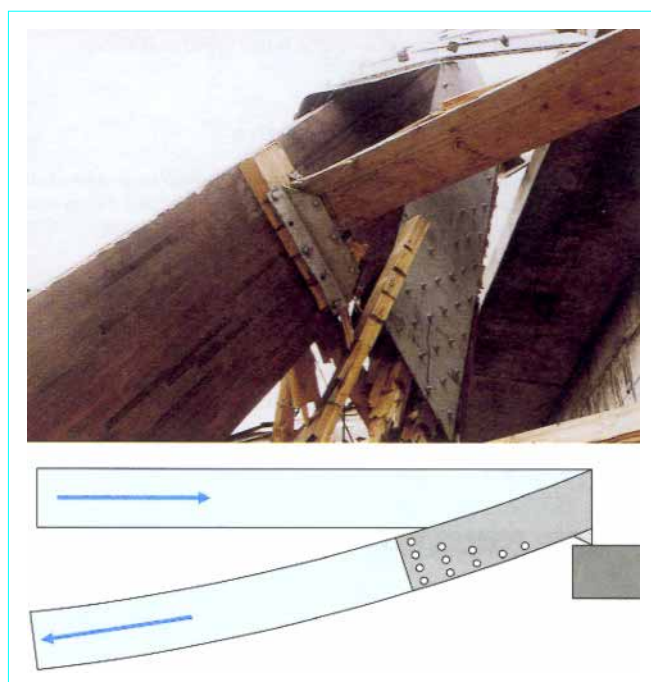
Effondrement d'une charpente par rupture différée d'assemblage
